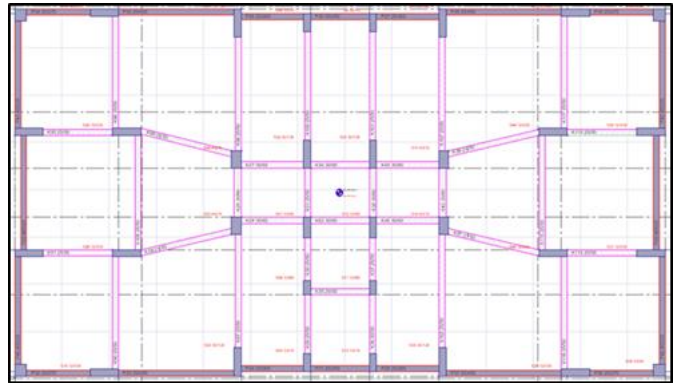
Yapımı tamamlanmış olan perdeli çerçevesel P1 planını oluşturan mevcut yapı planı
